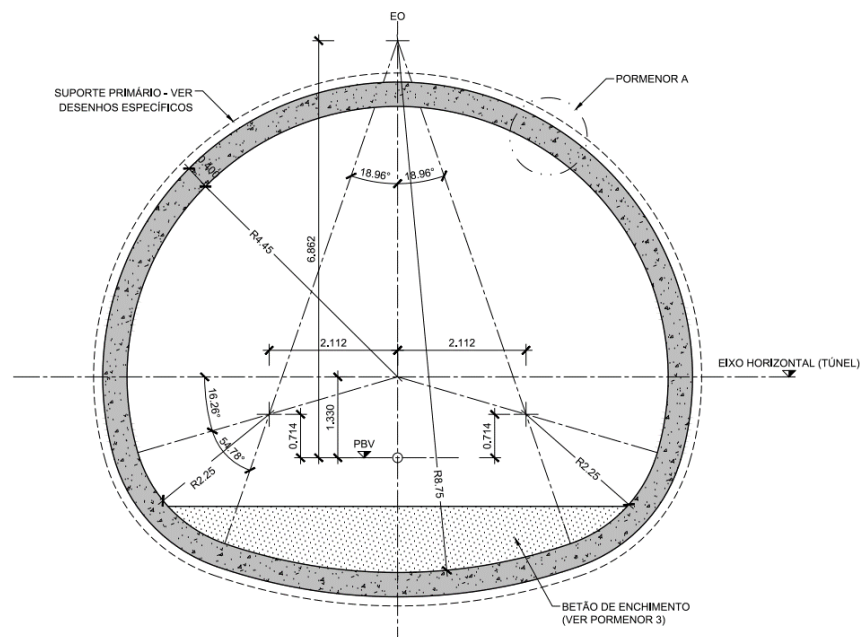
Revestimento Definitivo: Secção TV.2
